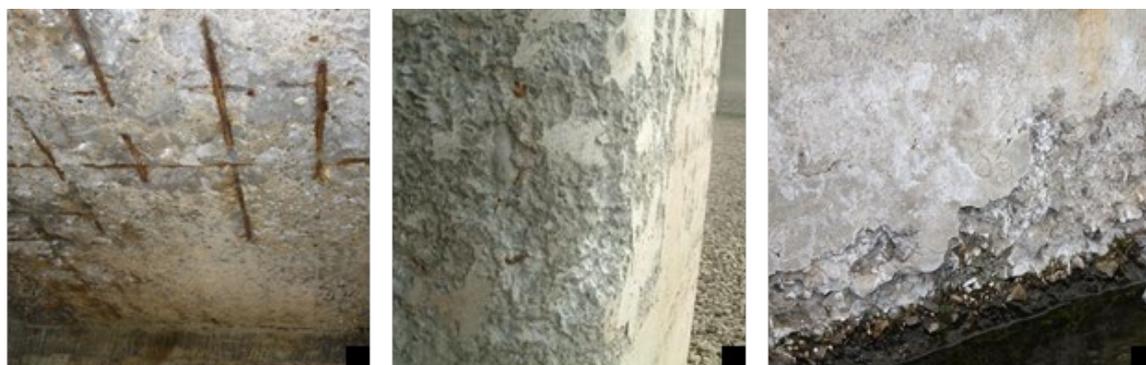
钢筋混凝土化学锈蚀（来源：周琦建筑工作室）
